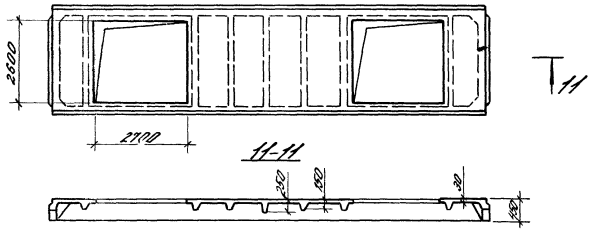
Плита типоразмера 2110,12 с двумя проемами для зенитных фонарей
